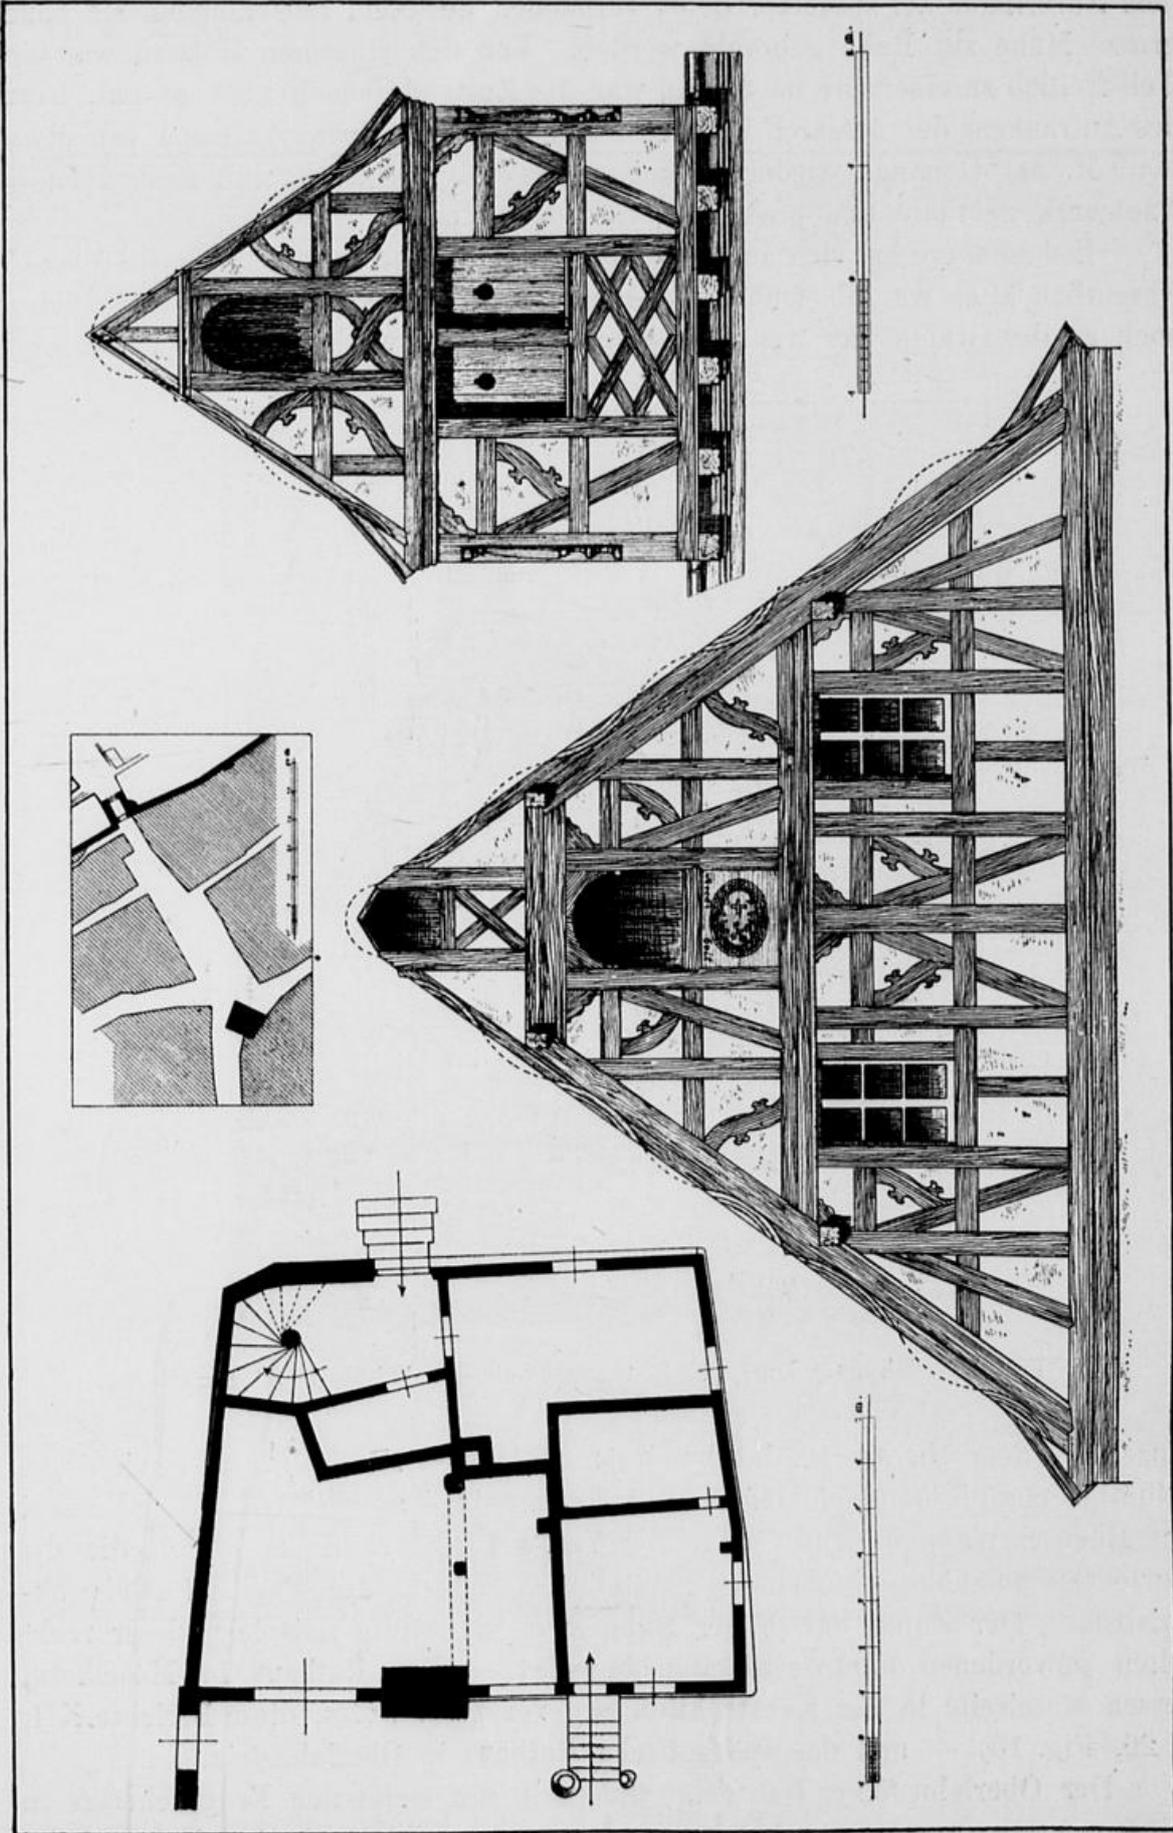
Rhens. Lageplan, Erdgeschoss, Grundriss und Giebel des alten Rathauses.
